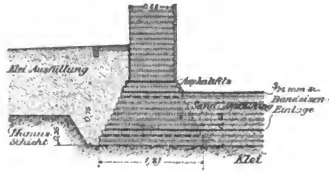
Mauerrost nach E. OTTO. M. 1 : 50.
